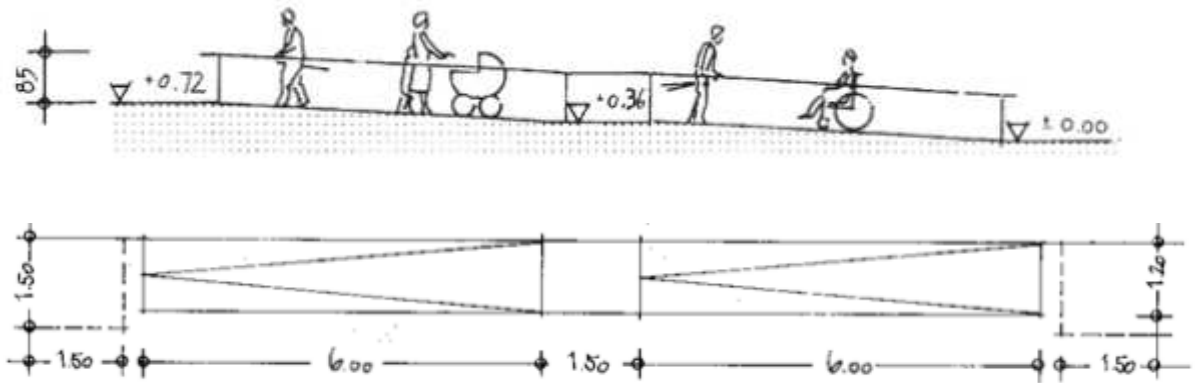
Rampe in Längsschnitt und Grundriss
